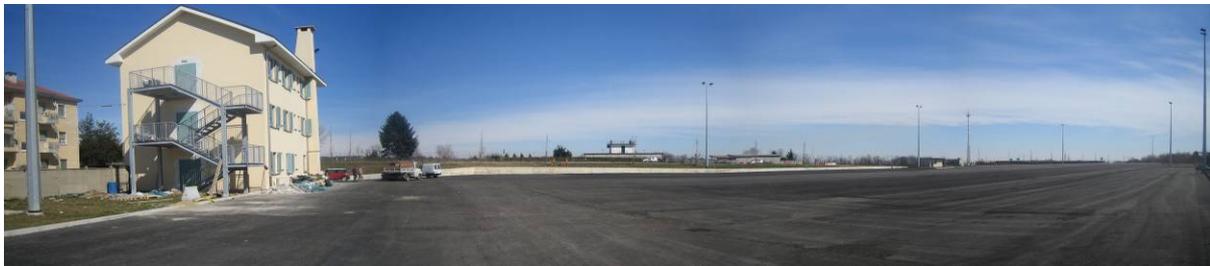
Vista dell'area d'intervento dal piazzale asfaltato
